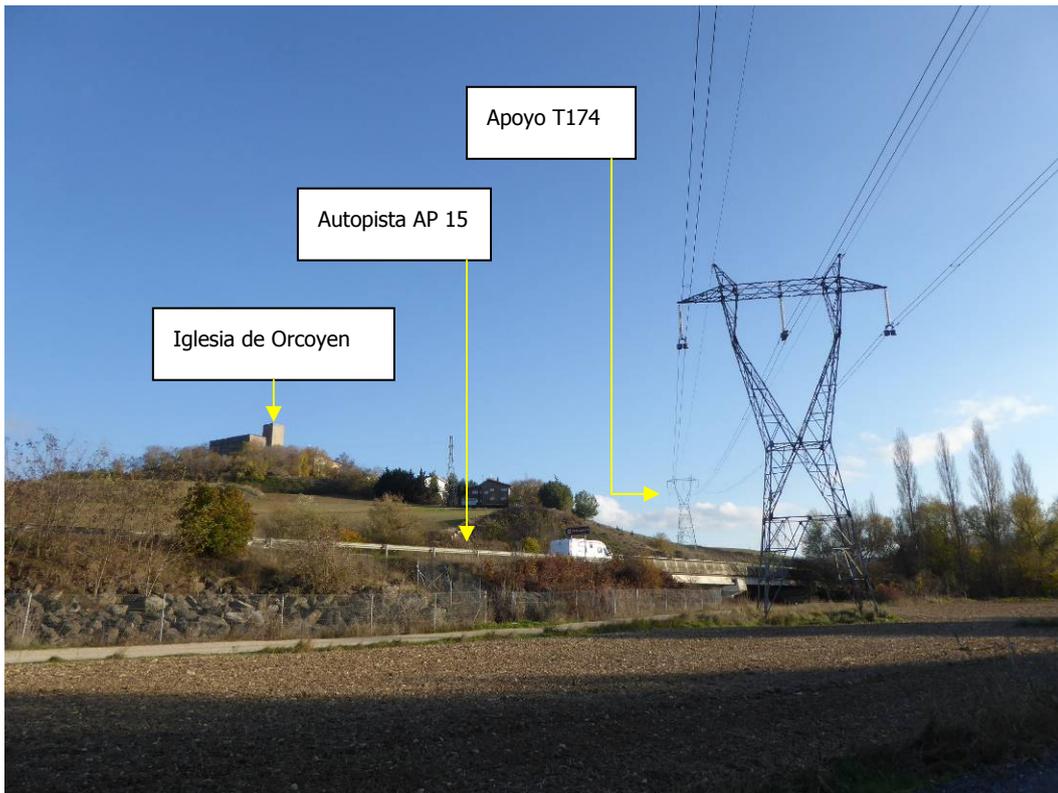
Apoyo T174, que se recrece 6 m por cruzamiento con autopista AP-15.
